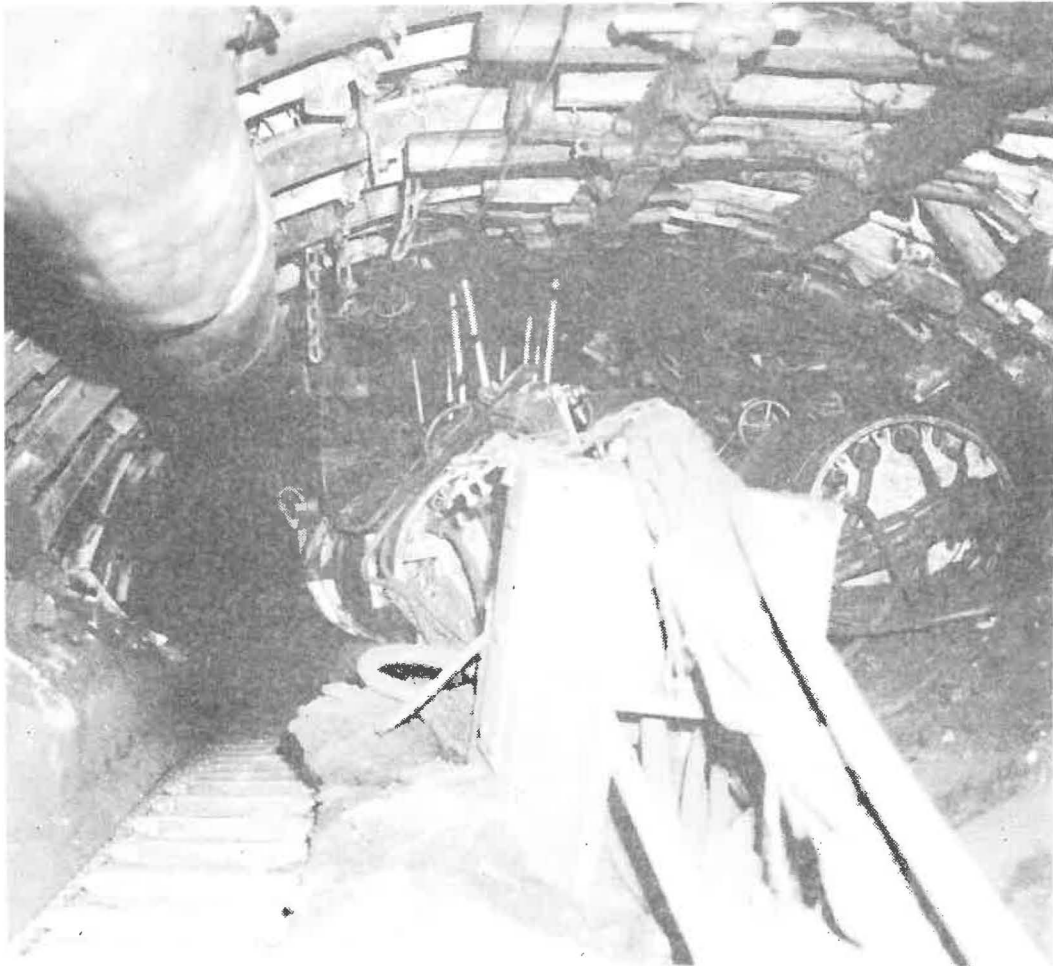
; Zicht op de baan na doortocht van de pijler.
